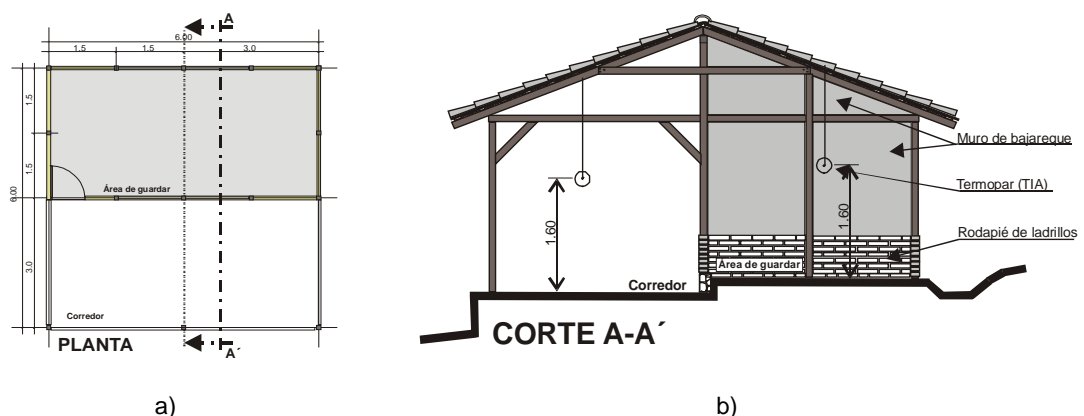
Casa de Chiapas: a) planta arquitetônica; b) localização dos sensores
